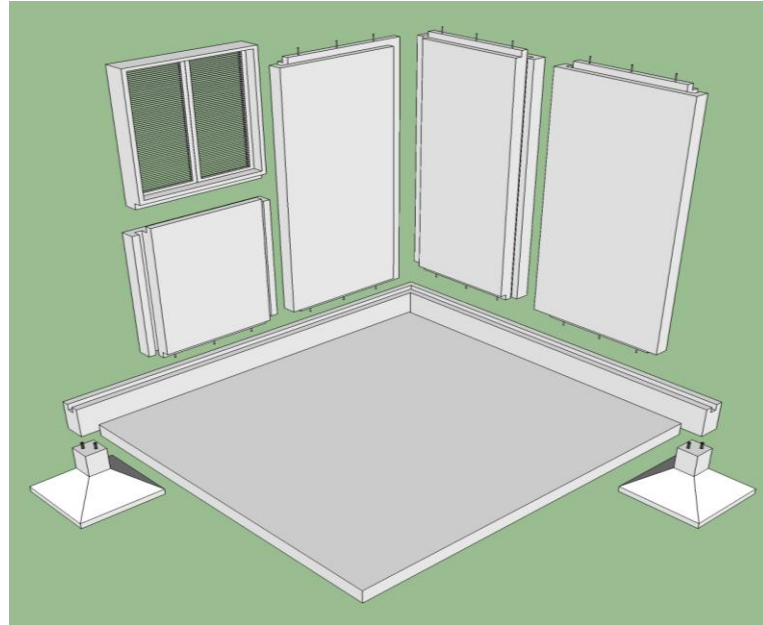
Proposta do sistema pré-fabricado em compósito cimentício.
